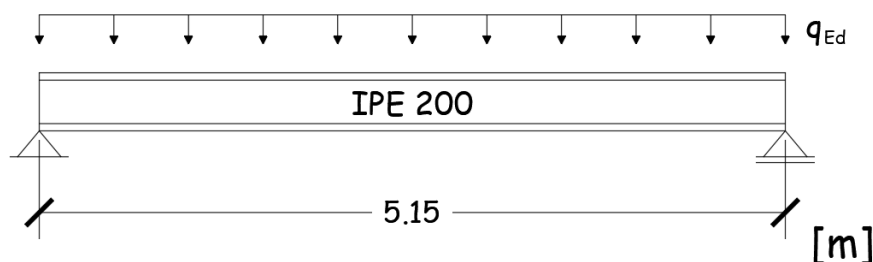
Representação da carga atuante na viga V2 do pavimento do piso 1
